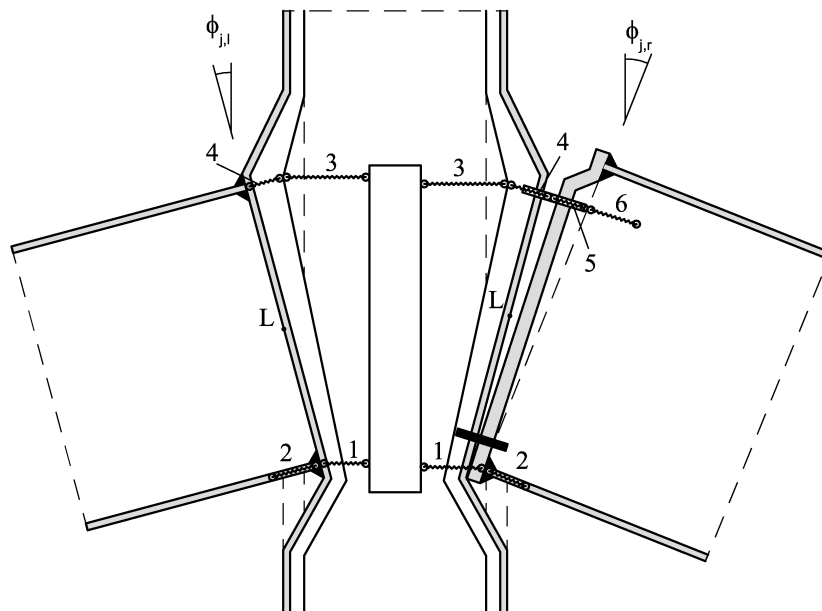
Verformter geschweißter (links) und einreihig geschraubter (rechts) Knoten
